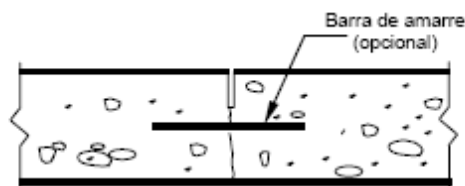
Junta longitudinal de contracción en toda la longitud del área por pavimentar.
